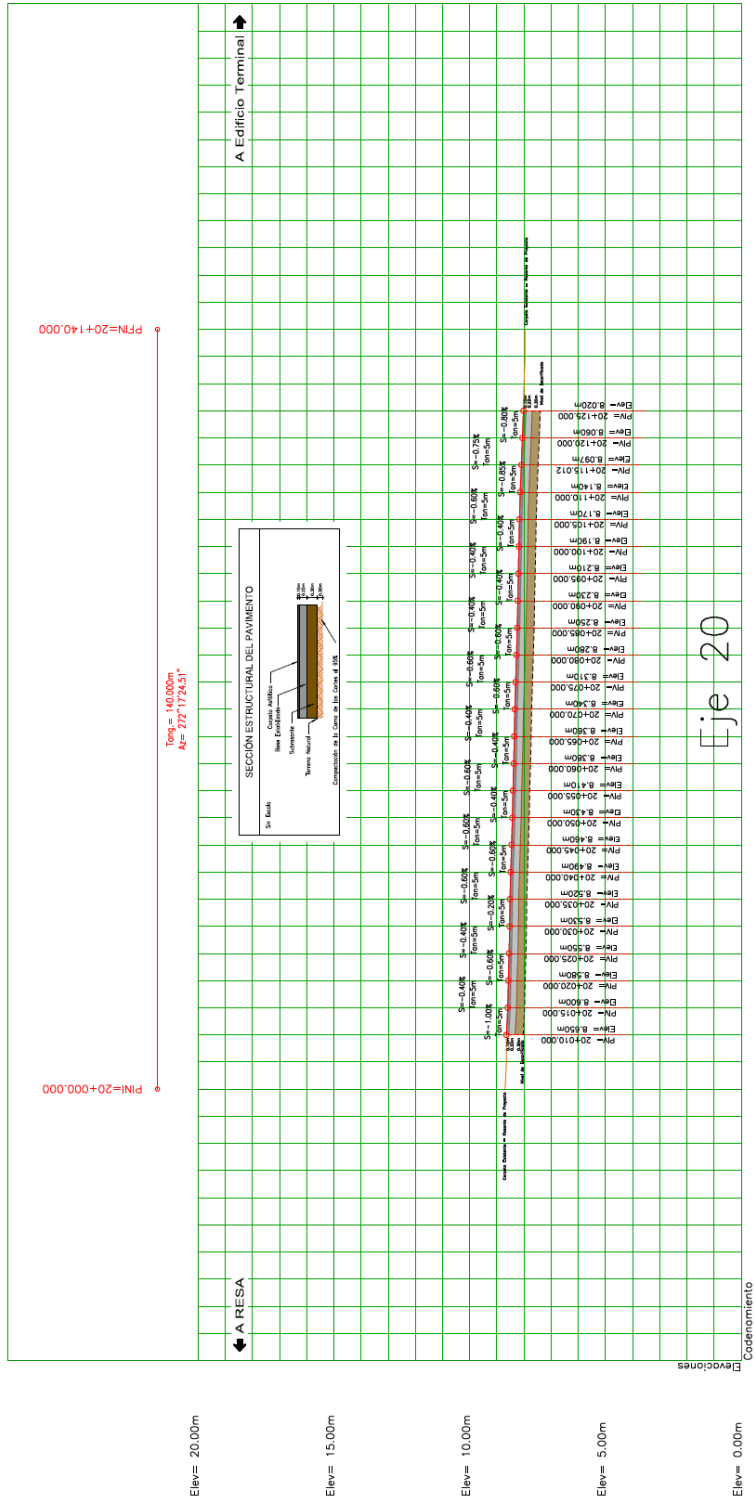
Perfil de Construcción del Eje 20 (Plataforma 26)¹³.
